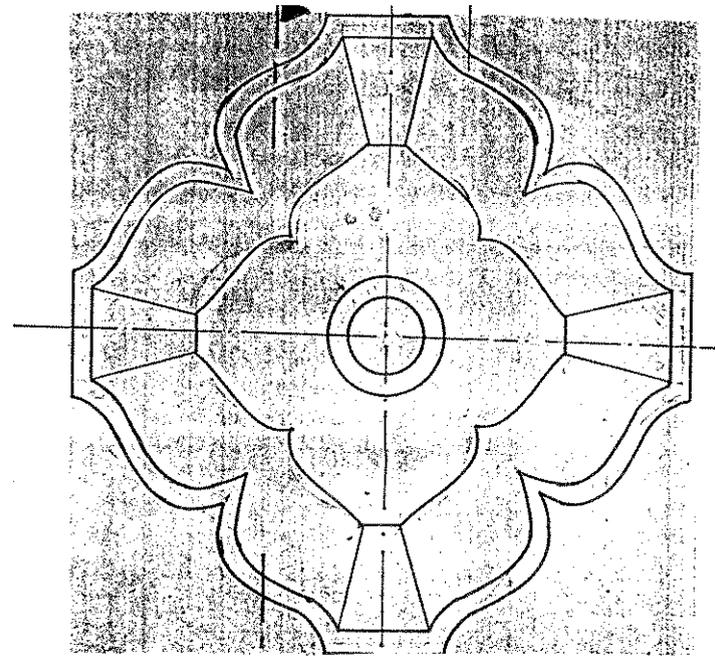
Detalle de Fuente ó Pila Colonial.
